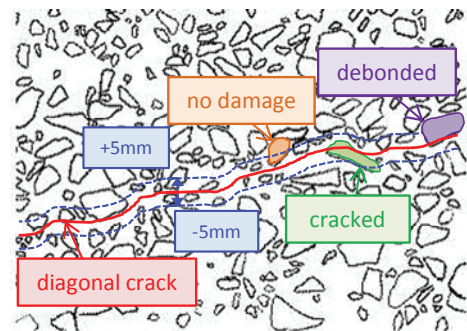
ひび割れ近傍における粗骨材観察の模式図
